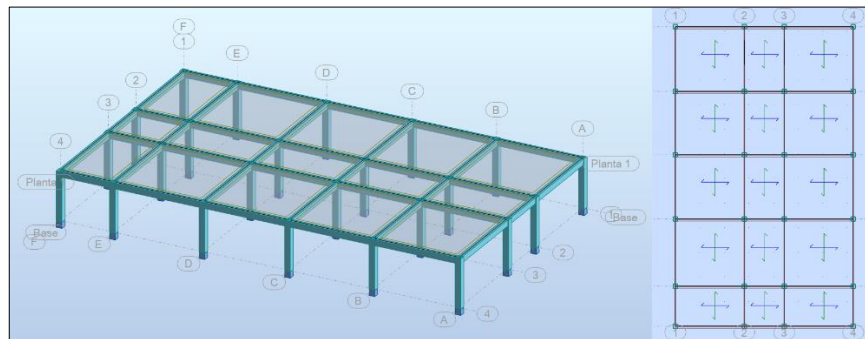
Dibujo de la cubierta liviana de la estructura 1 del Centro Vida.
